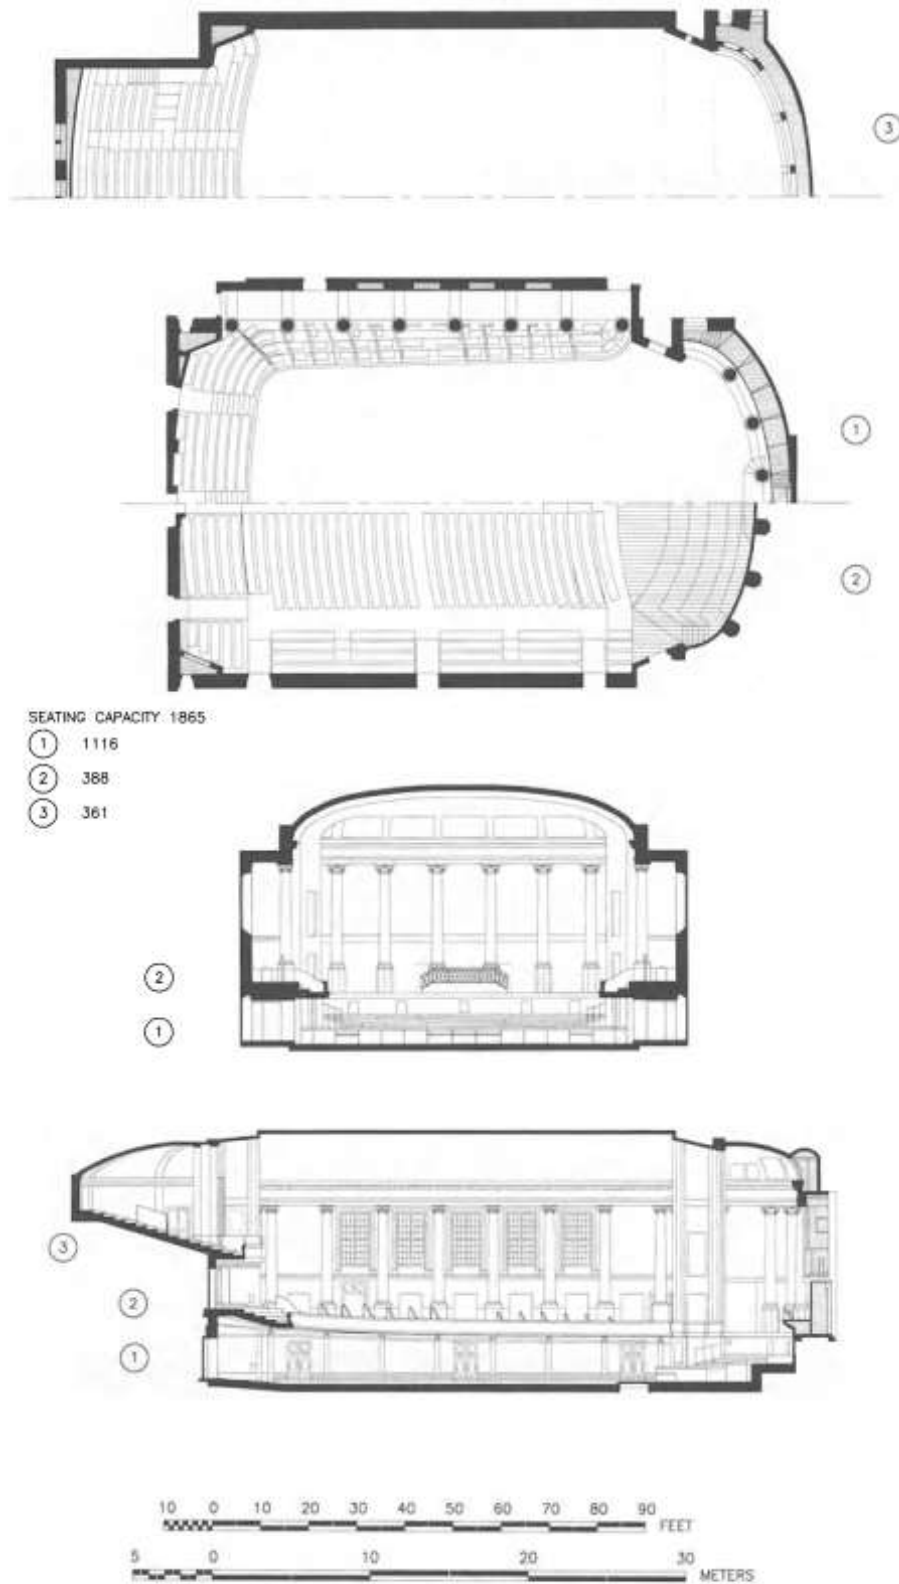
Grundriss, Frontalansicht und Seitenansicht Wiener Konzerthaus [Beranek 2004, S. 179]
